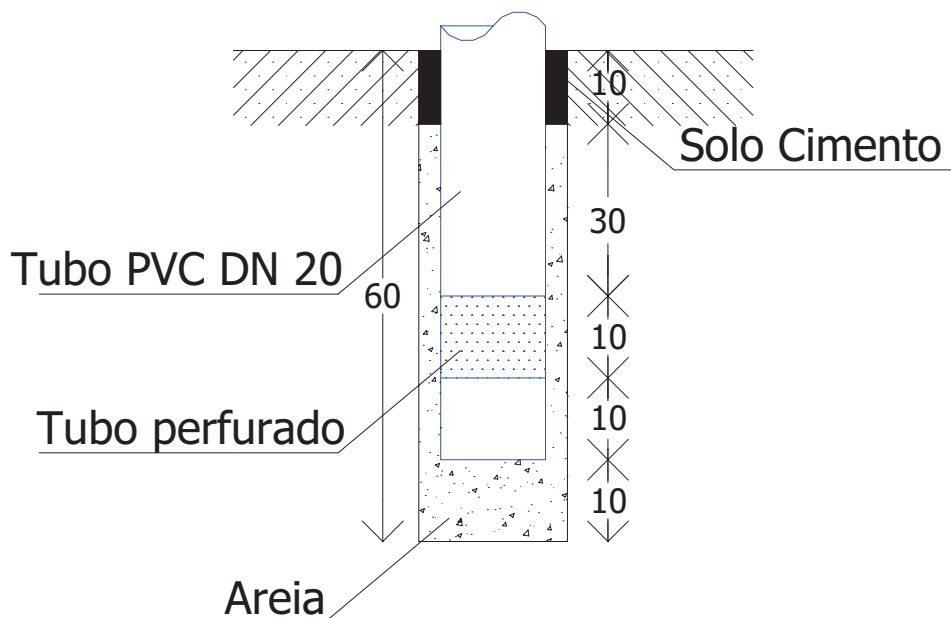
Desenho da execução de ensaio de infiltração.
